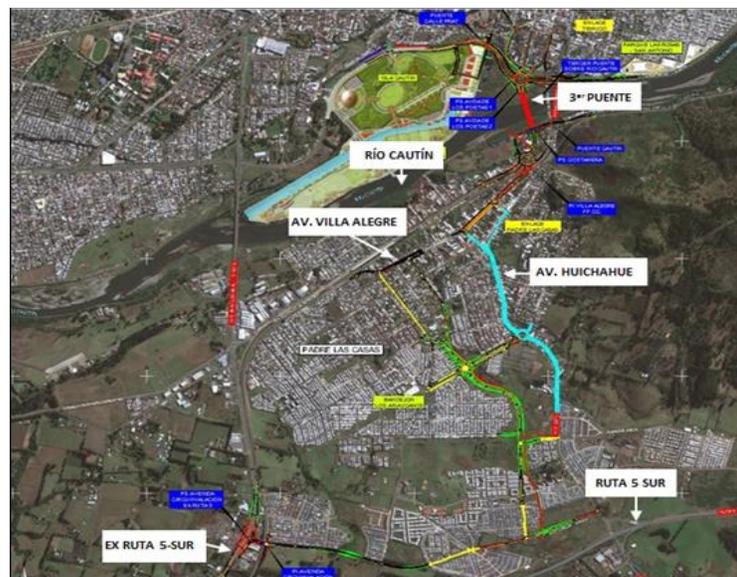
Proyecto interconexión Vial Temuco – Padre Las Casas
